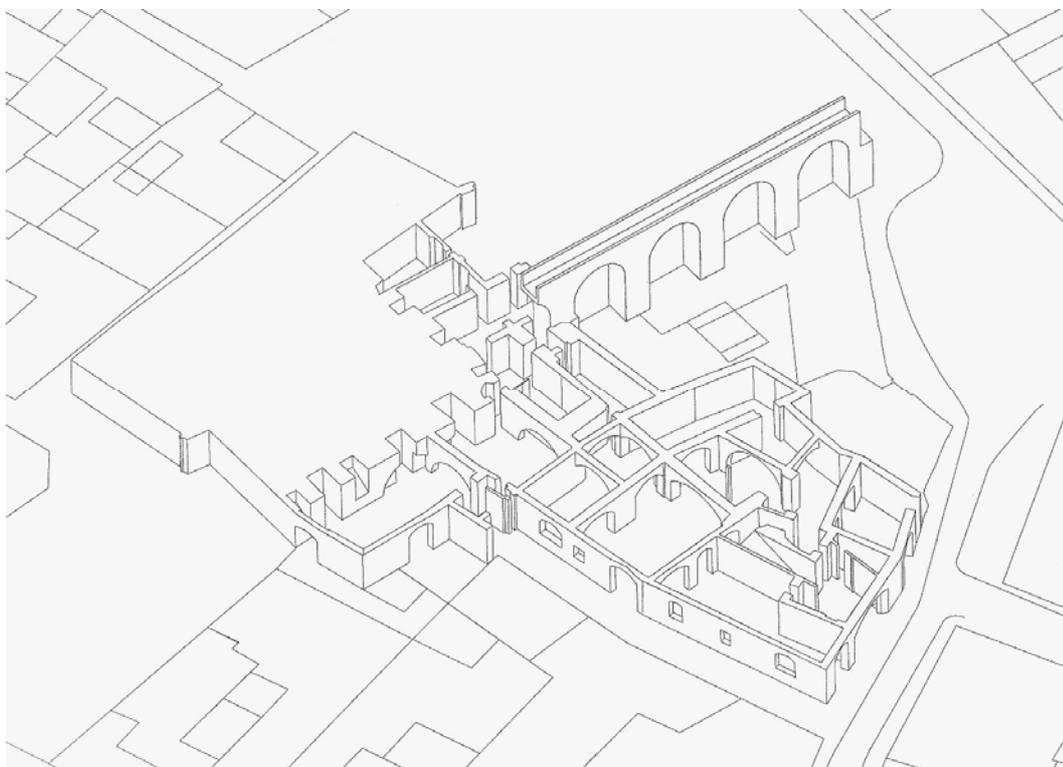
Reconstrucción en perspectiva de la planta baja (Rahola y Cortellaro, 2007).
